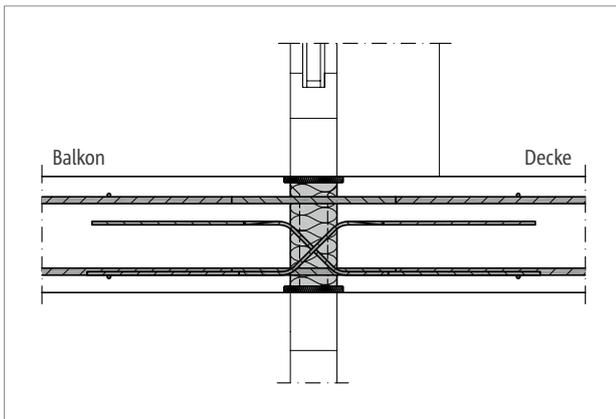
Schöck Isokorb® T Typ D: Einbauschnitt; einachsig gespannte Decke
